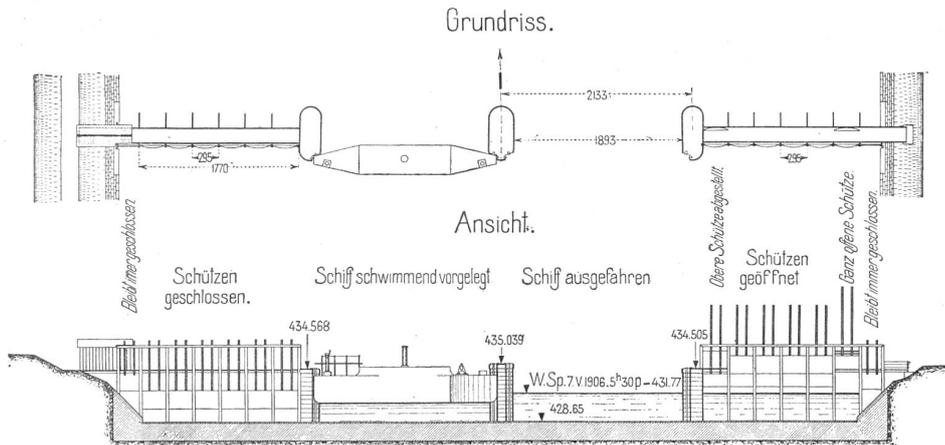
Die Vergrösserung des Niederwasserabflusses aus den Juraseen. Das Nidauerwehr vor dem Umbau. Ansicht und Grundriss. 1 : 800.
